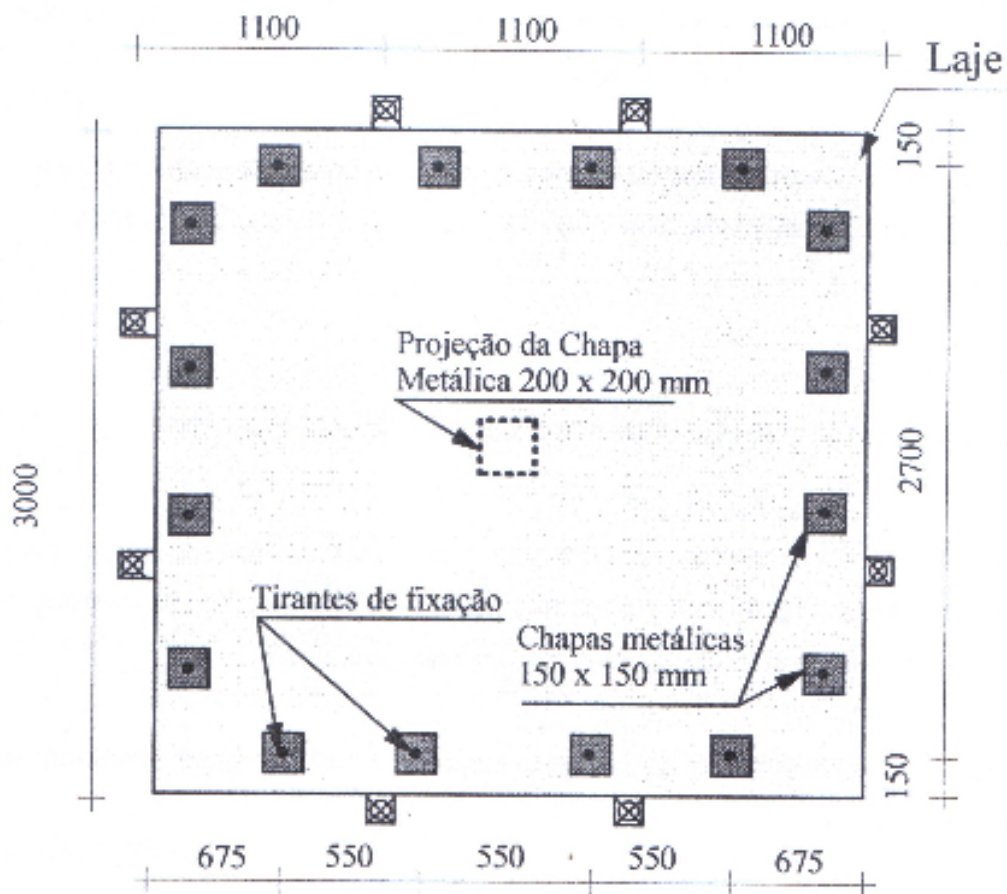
vista em planta (TRAUTWEIN, 2001, p. 45)
